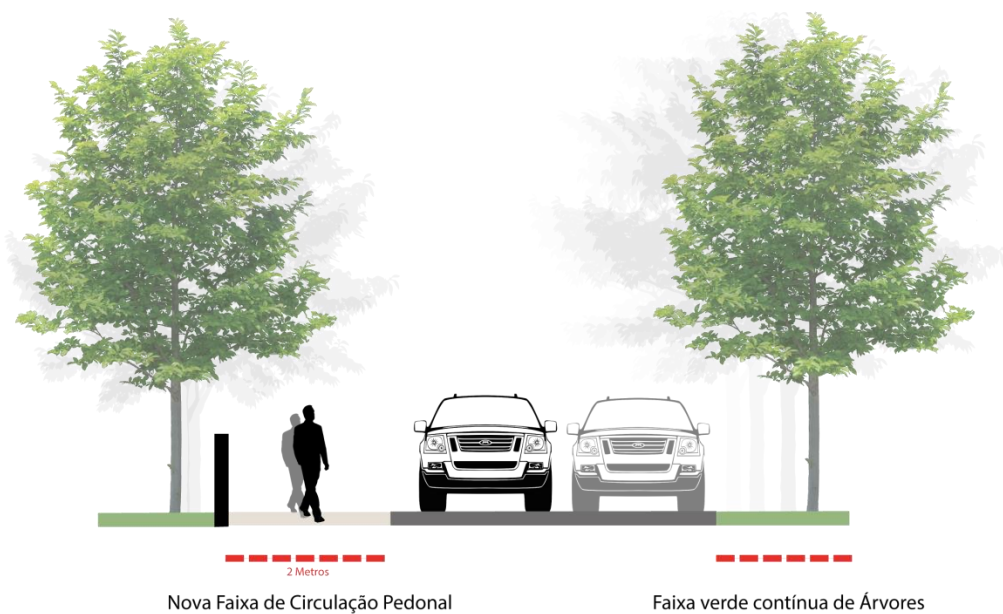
Perfil tipo ilustrativo da Proposta para a Rua Canos
